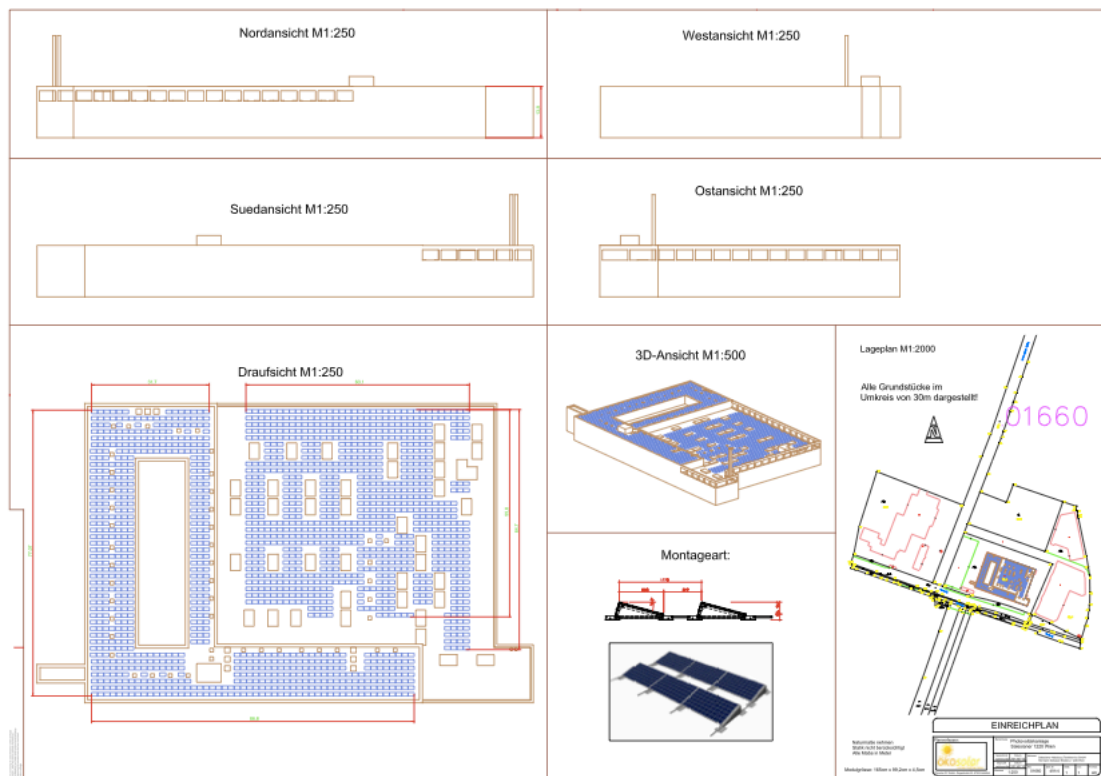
Einreichplan Aufdachanlage Wien 22, Quelle: Sunmade
